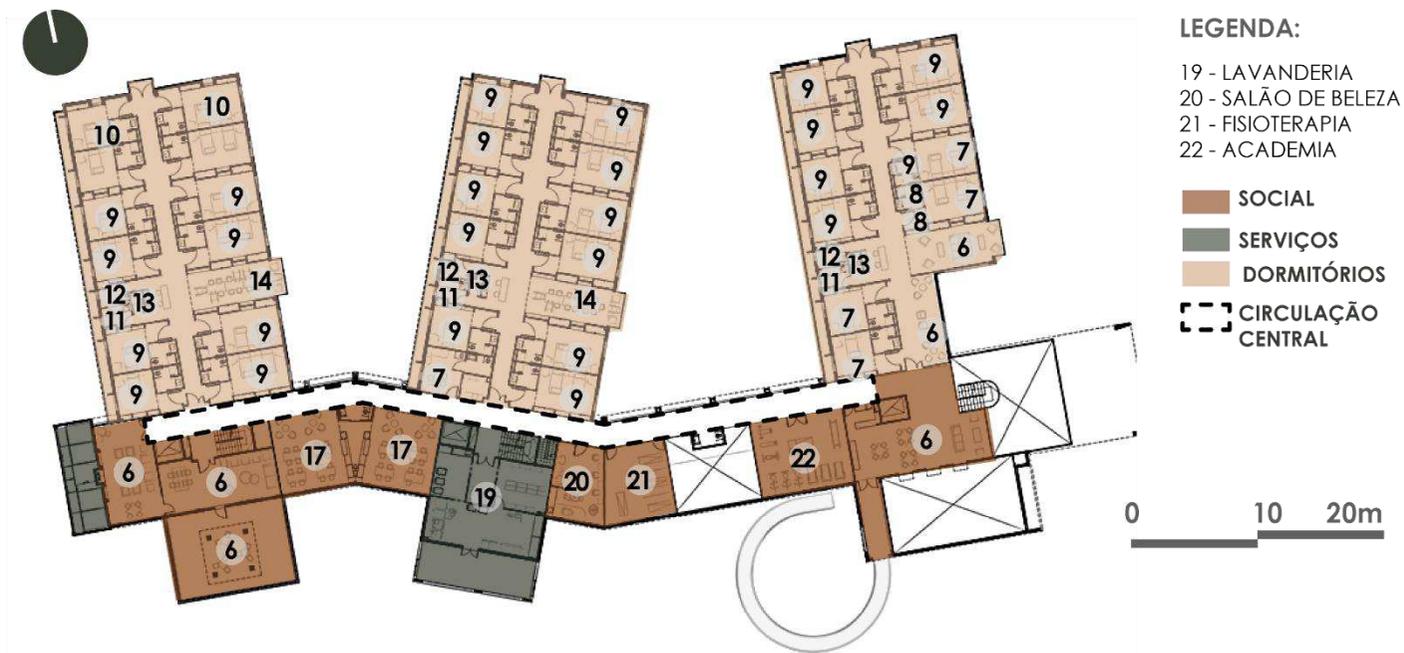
Planta baixa zoneada - Pavimento superior.
